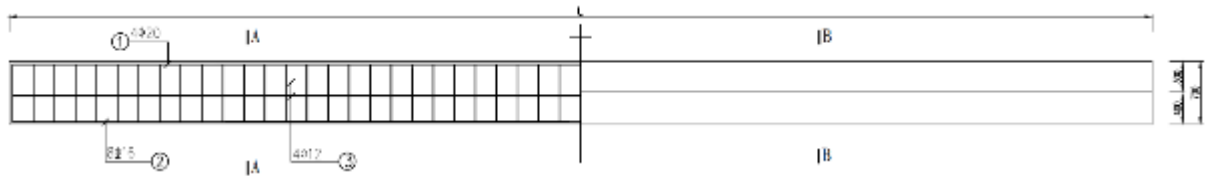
Diagrama de refuerzo de elevación para viga de cimentación de grúa 80 Tn
